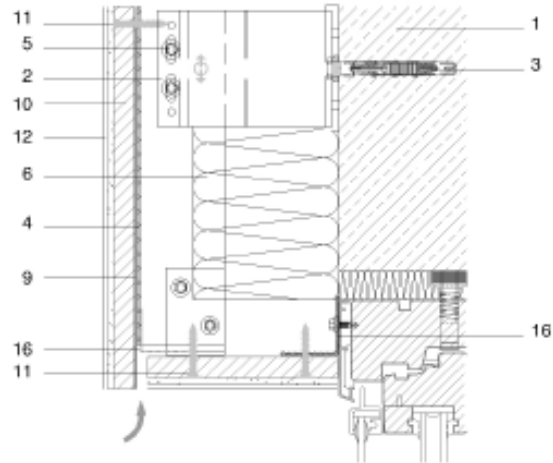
Detalhe construtivo de lintel com placas Glasroc X – Corte Vertical [78].
